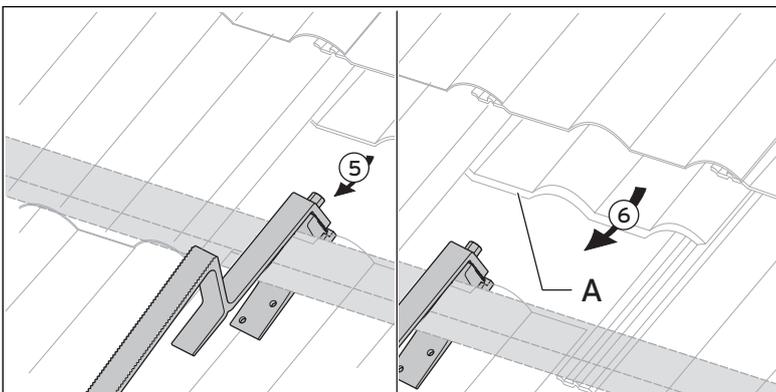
Dachanker Typ P an der Dachlatte befestigen
